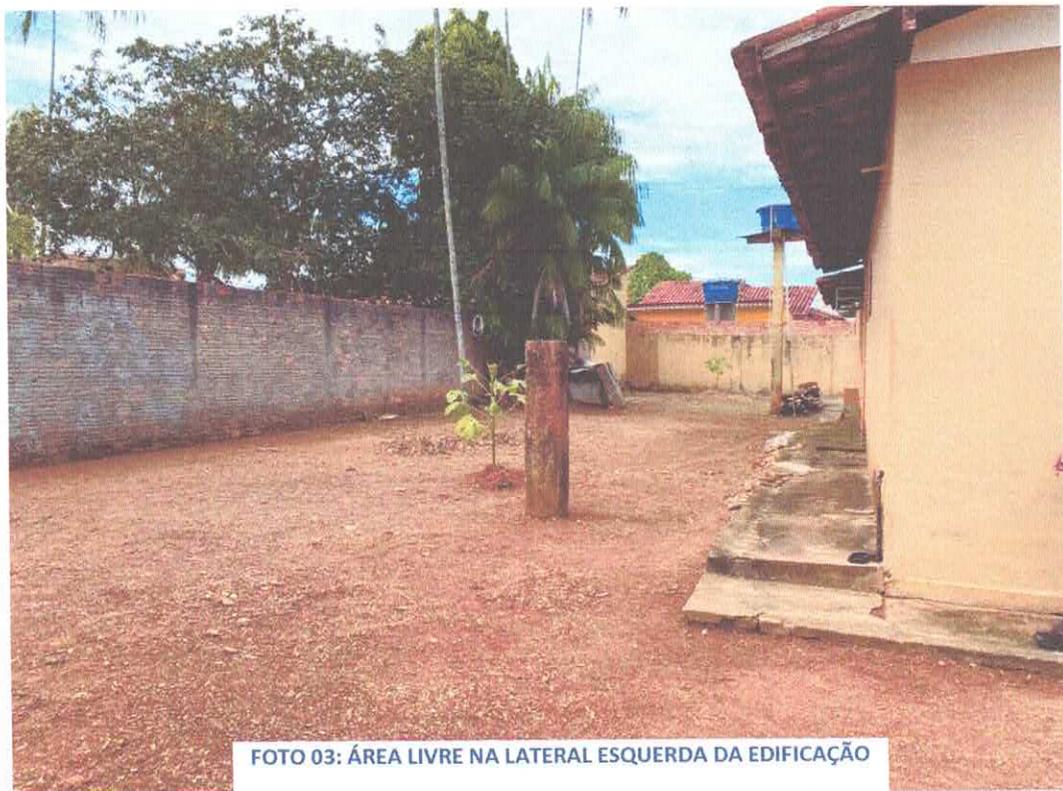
ÁREA LIVRE NA LATERAL ESQUERDA DA EDIFICAÇÃO
